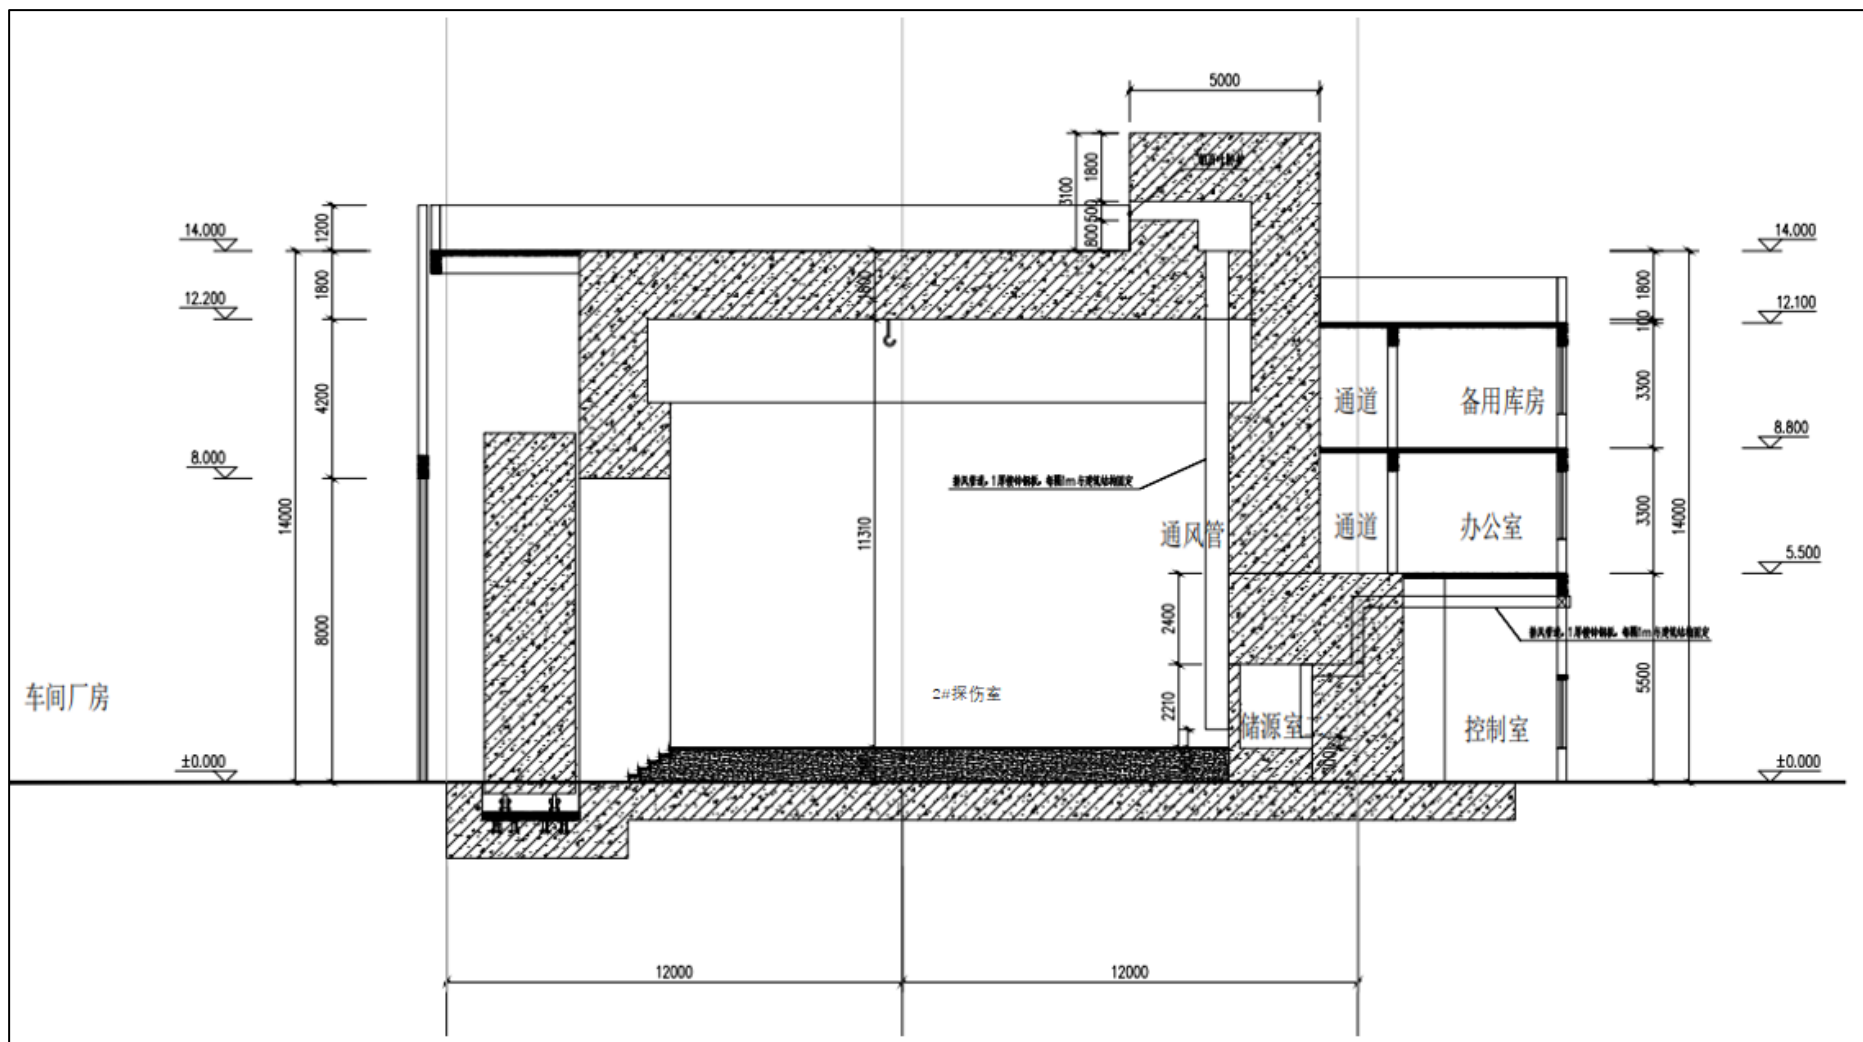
2#探伤室通风管道剖面图 (单位: mm)
